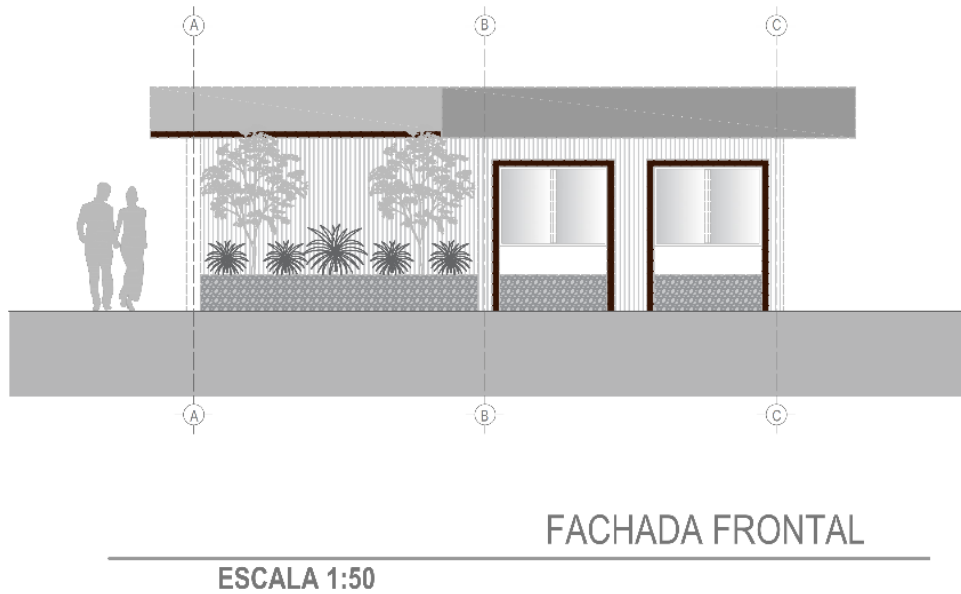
Fachada principal CAI. Fuente: Navarro, M., 2018.
